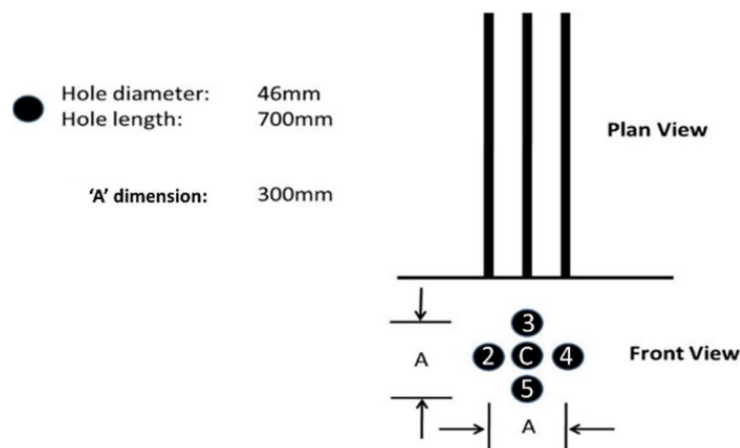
П'ятишпурова схема типу «алмаз» для формування вільної поверхні
